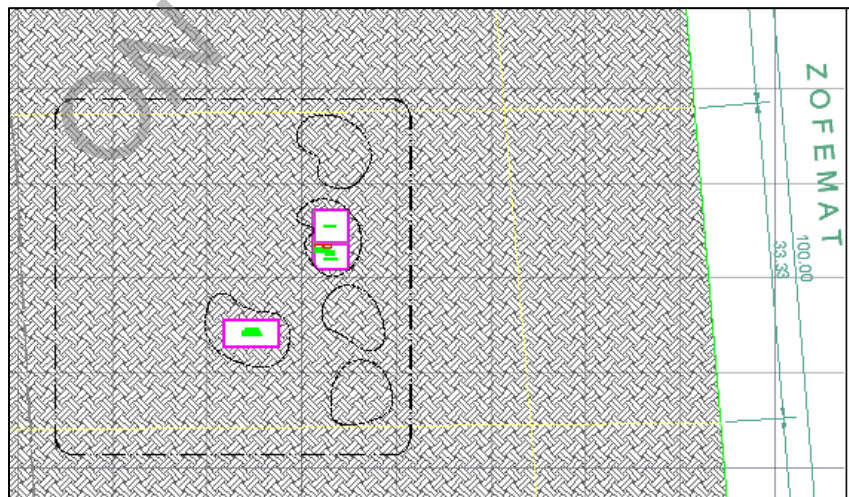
Plano de ubicación de las instalaciones con excavación.
